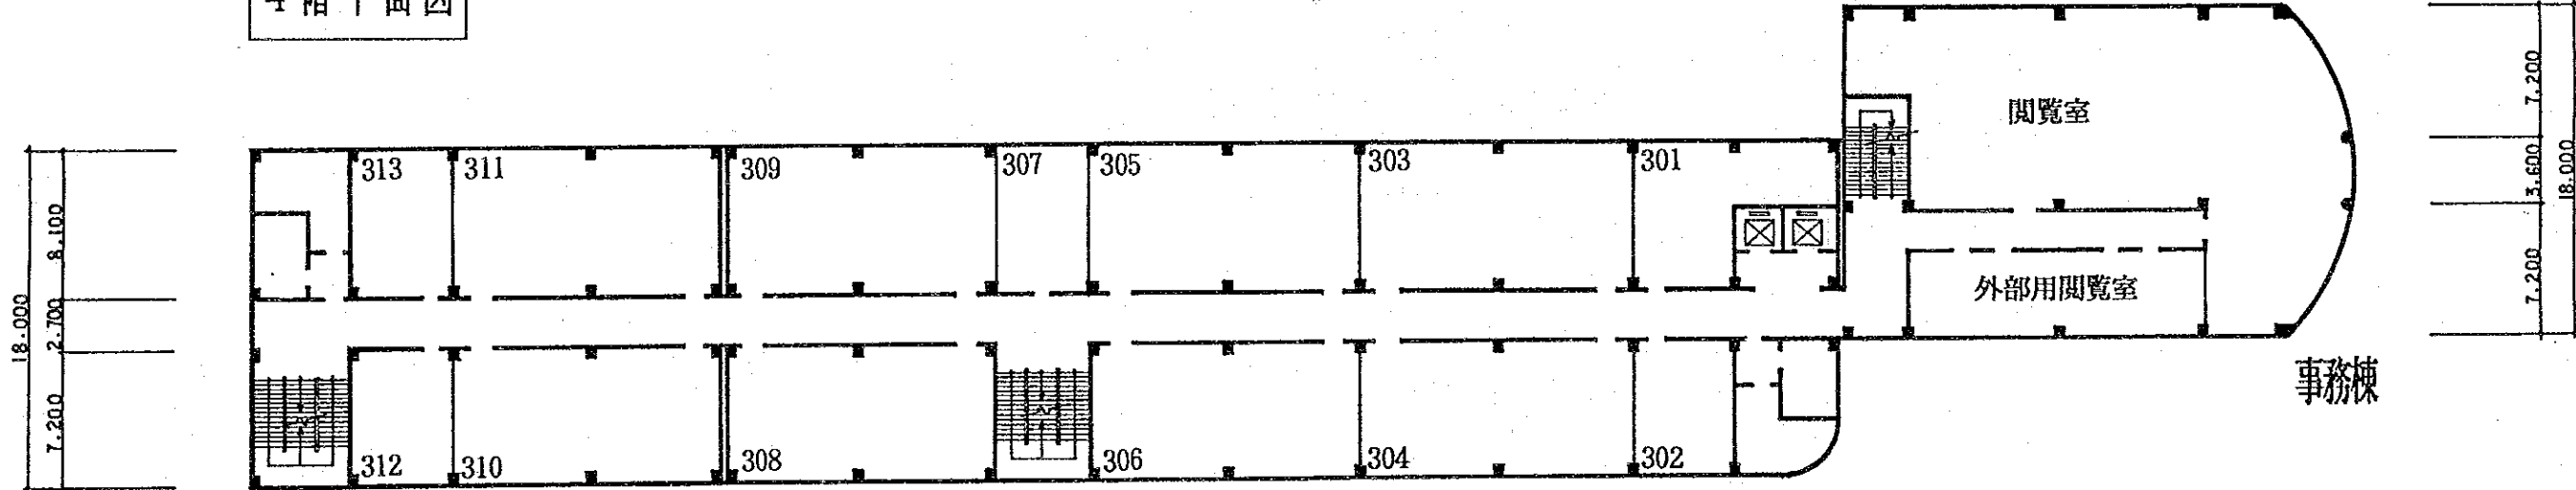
実験実習棟・事務棟 3・4 階機材配置図
